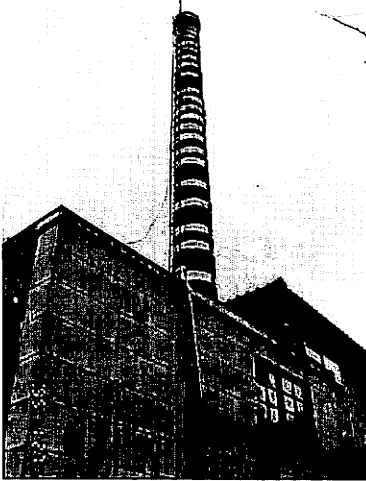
鉄板で補強していたために損傷を免れたRC造煙突
